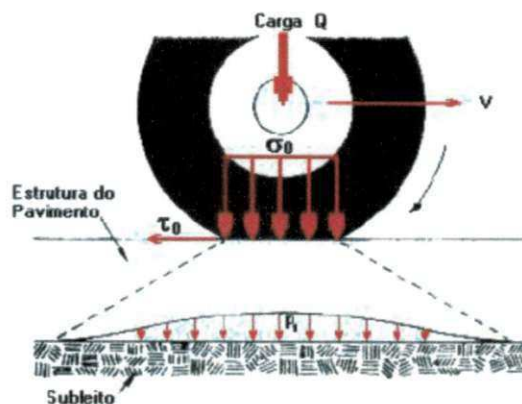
Cargas no pavimento flexível (Fonte: SANTANA, 1993)
